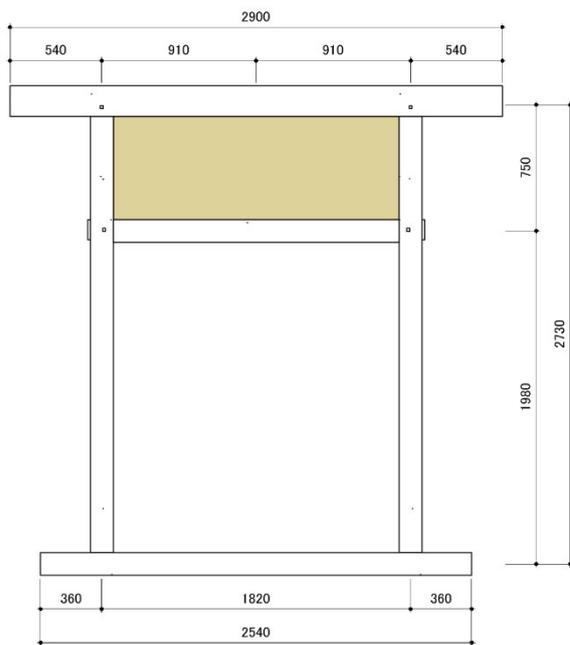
試験体 4 (垂れ壁) 試験体詳細
